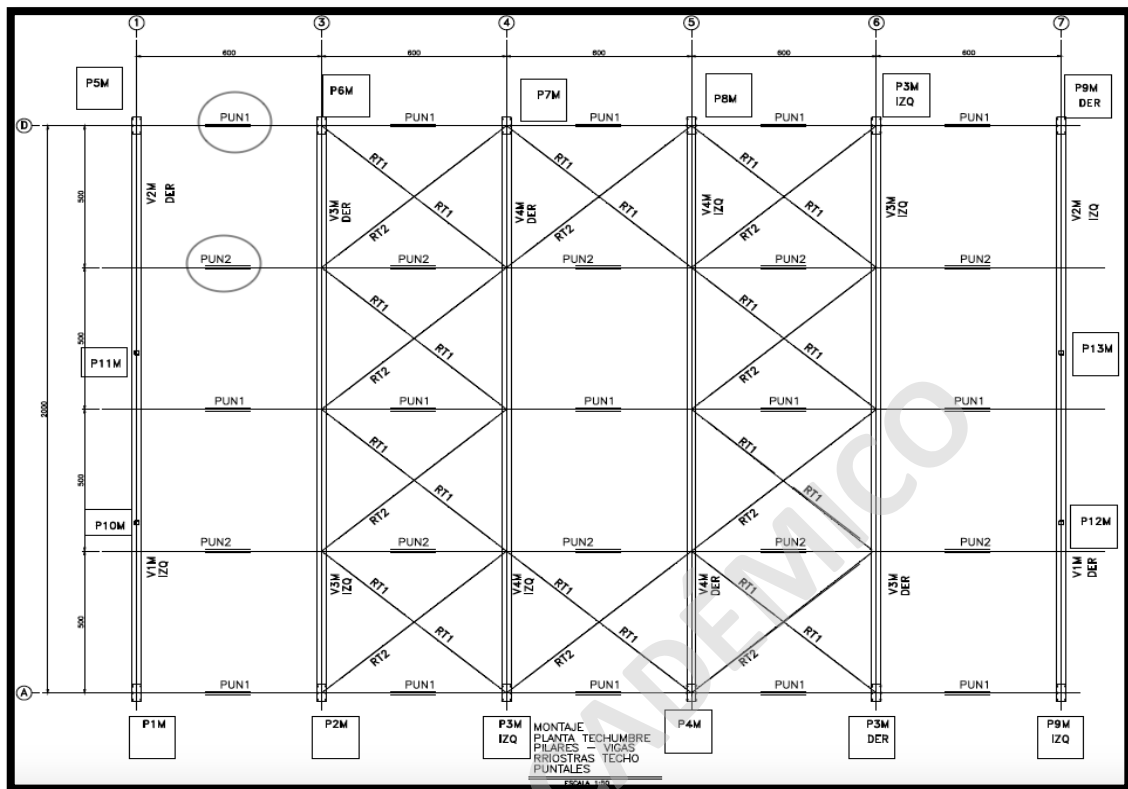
Planos de montaje de ODR Ingeniería y Montaje
